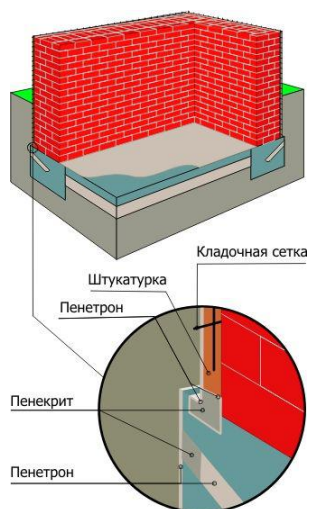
Гидроизоляция по кирпичной стене снаружи
